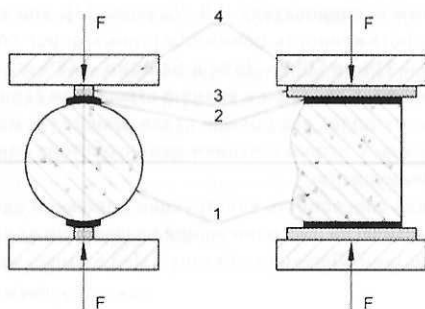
Схема испытания на раскалывание керна с продольными подливками: 1 – керн; 2 – продольные подливки; 3 – фанерная прокладка; 4 – плита пресса; F – сжимающее усилие.
